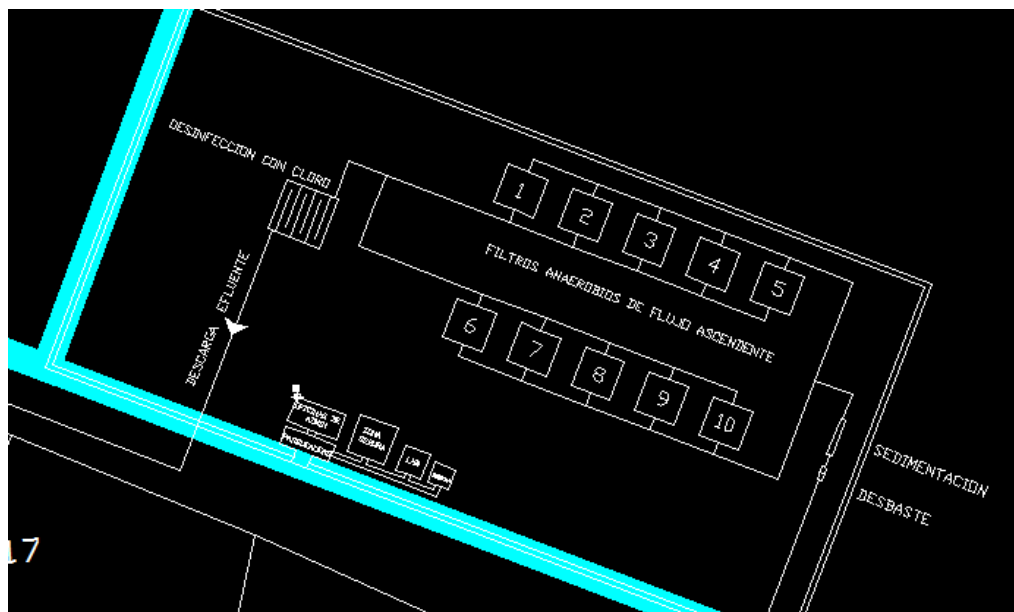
Esquema de planta de tratamiento en Ubicación 2
